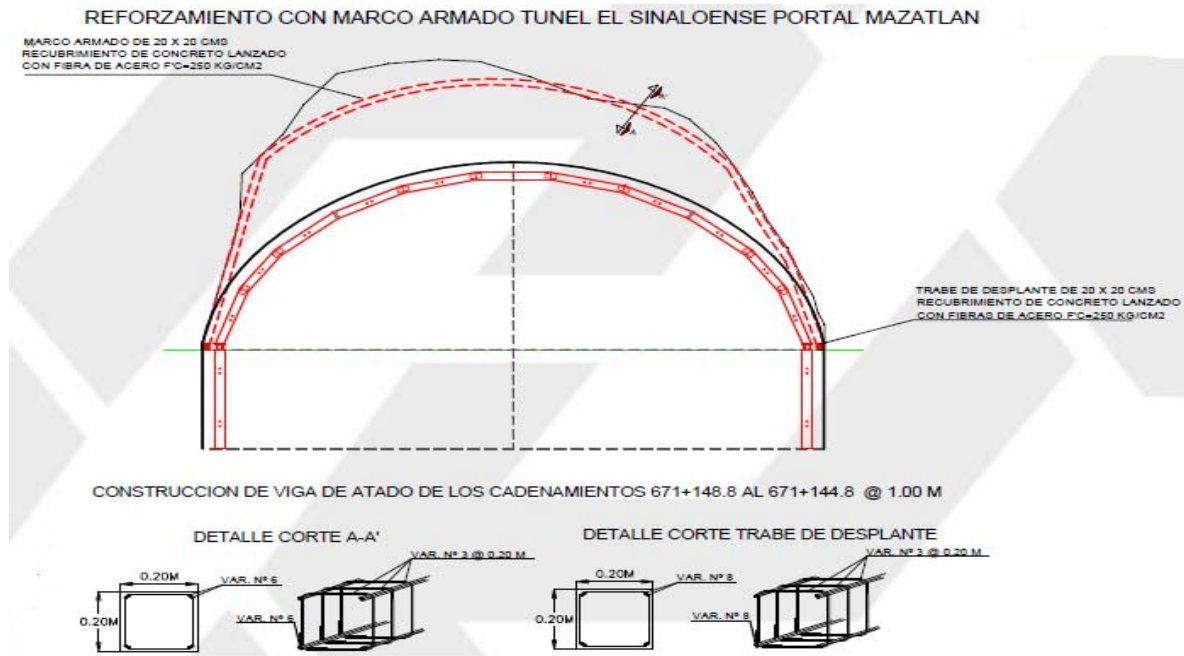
Marcos de acero de refuerzo y concreto lanzado
